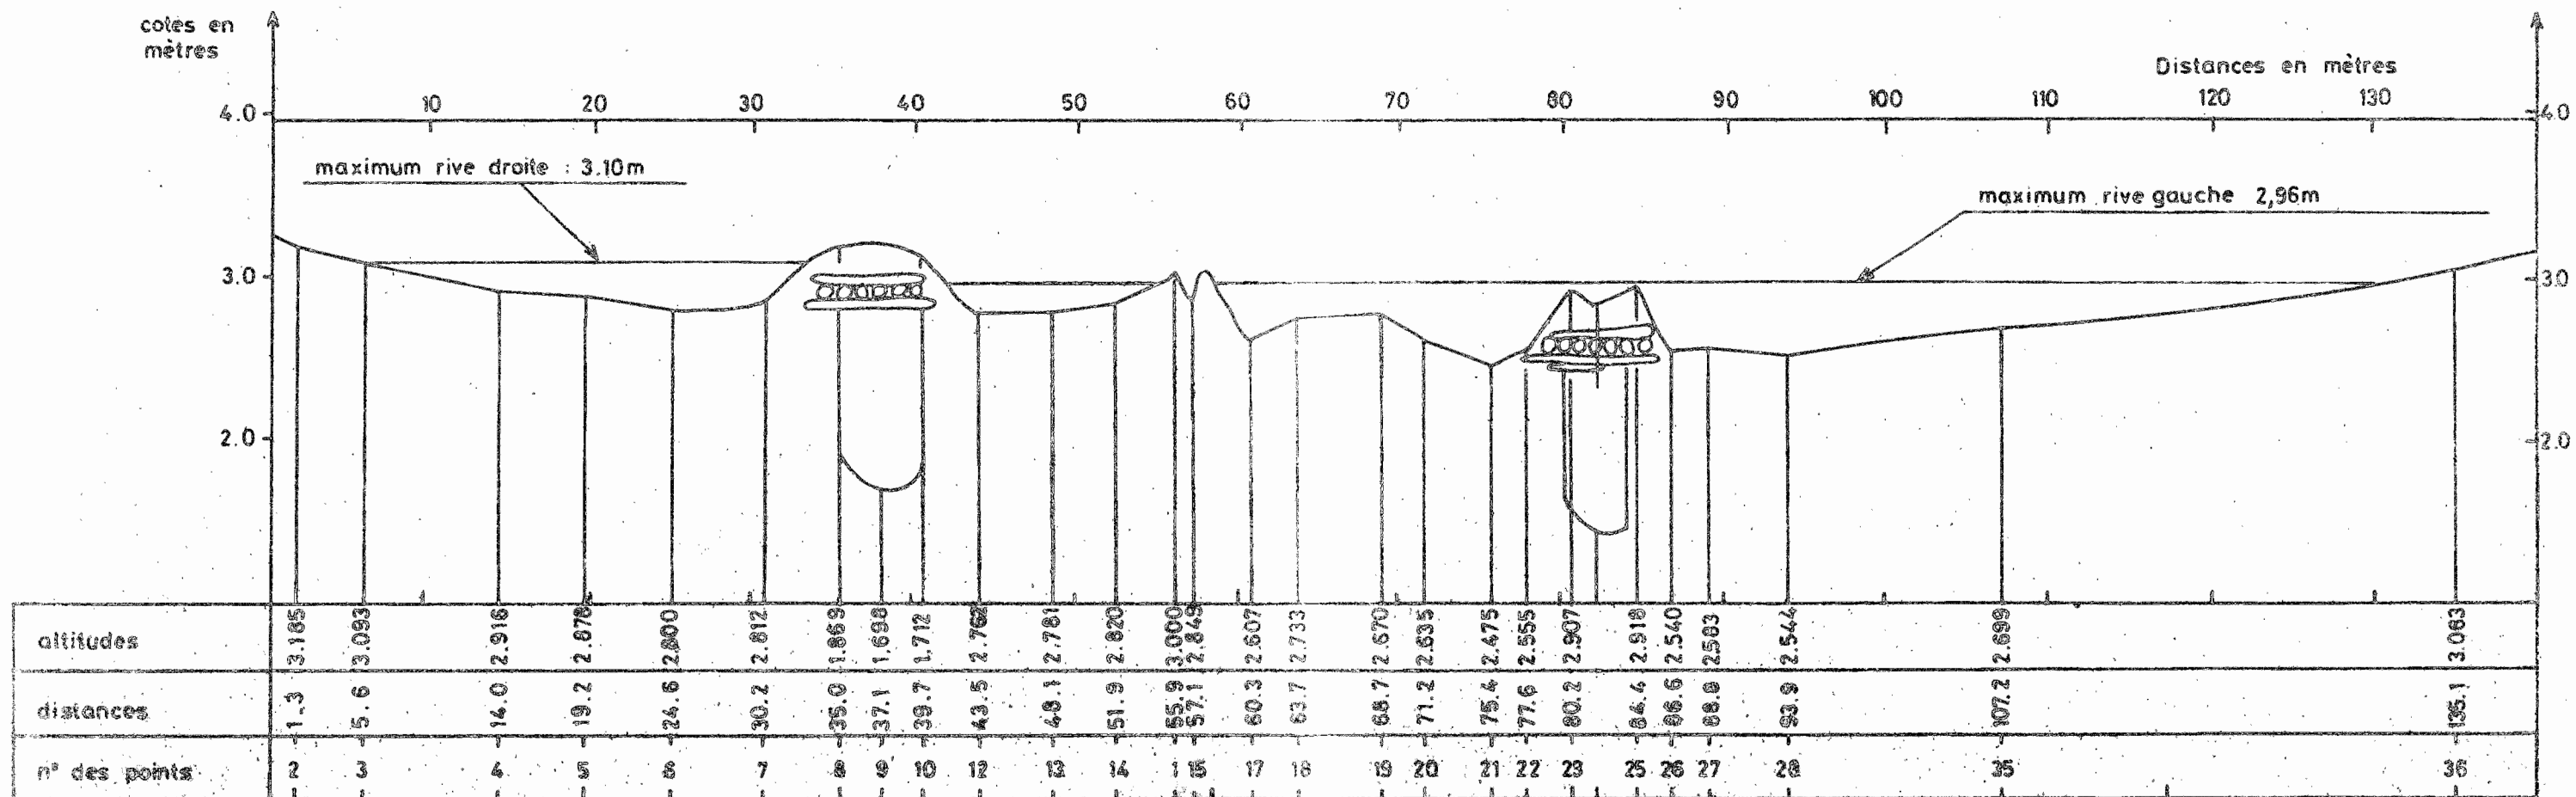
PROFIL EN TRAVERS DU BLETOU A KANGOURA Le 14 AVRIL 1987
